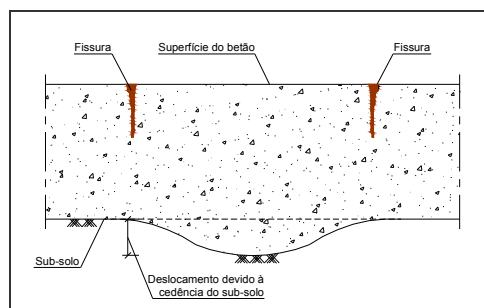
Fissura por cedência do subsolo.
